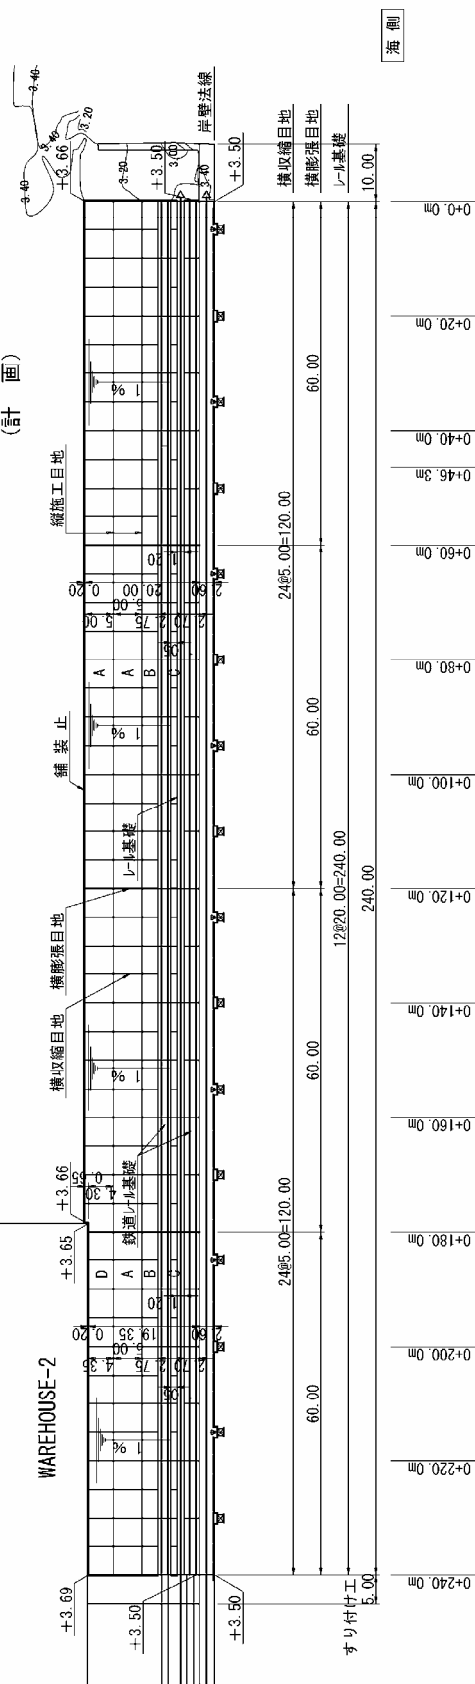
(18) ナミベ港 エプロン舗装平面図
